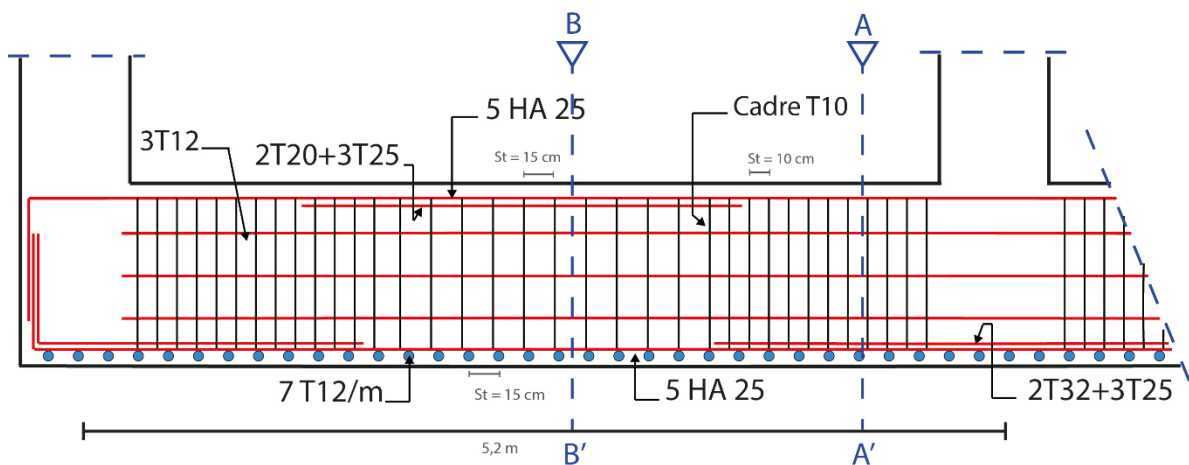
Schéma de ferrailage de la semelle filante « coupe longitudinal ».
